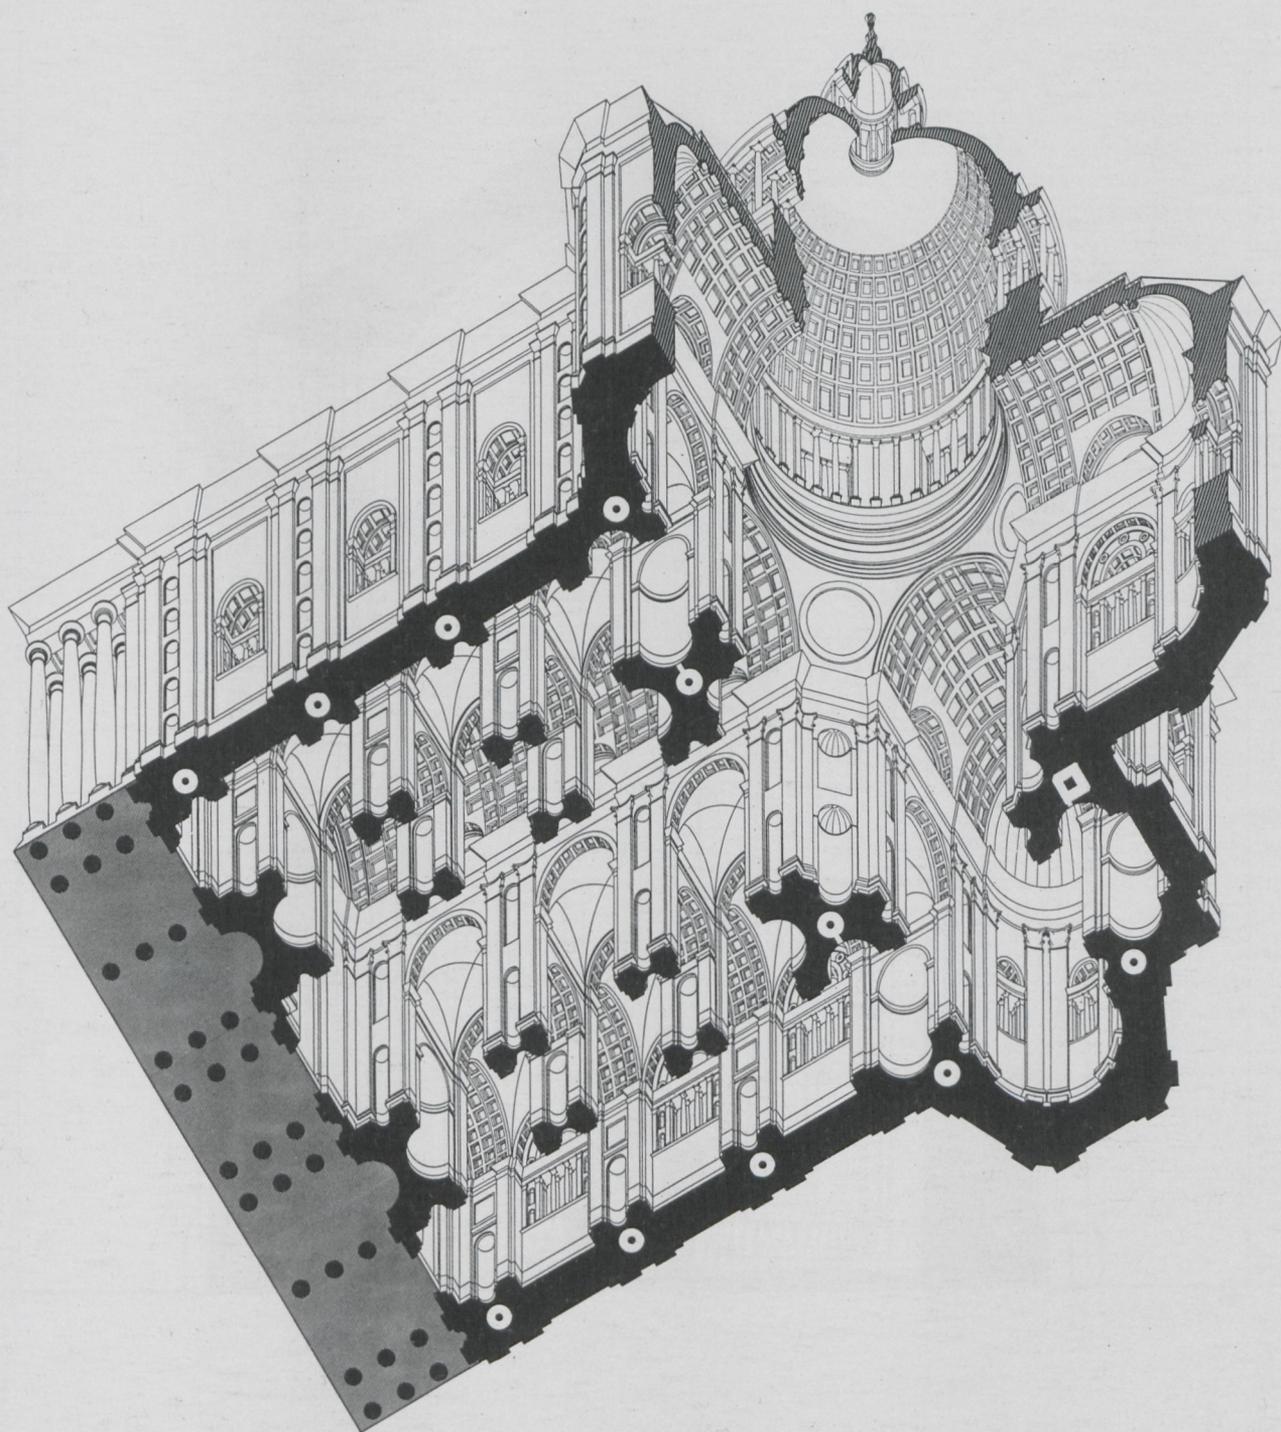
Ricostruzione ipotetica del progetto bramantesco dell'aprile 1506, pianta con zona vaticana (disegno P. Foellbach)
